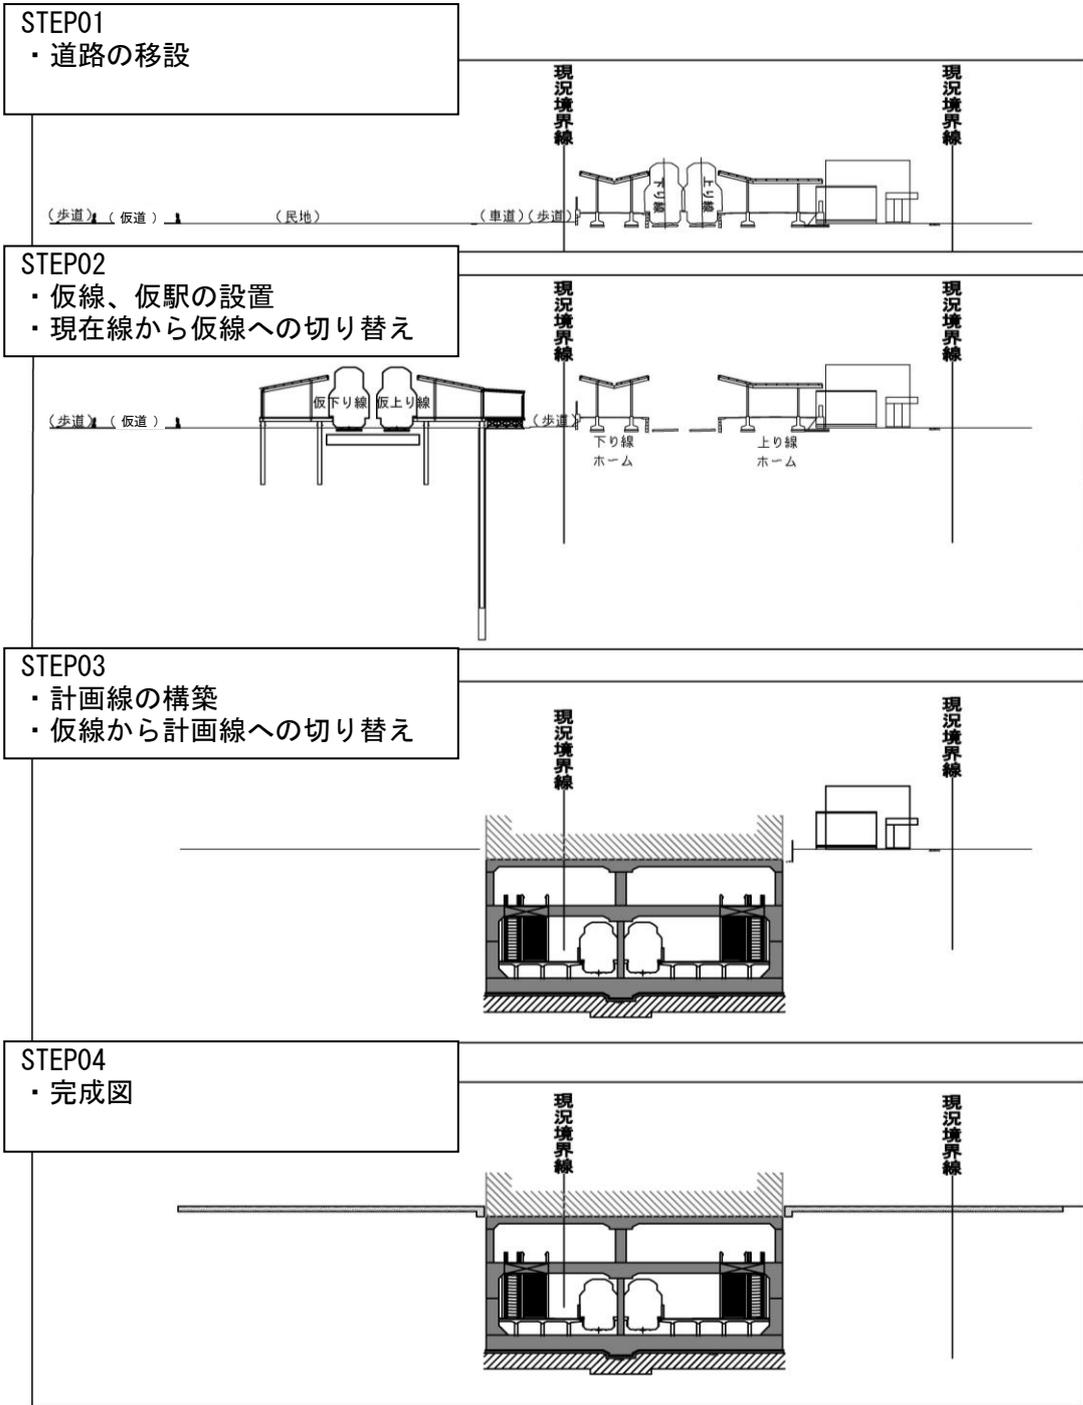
施工ステップ図 (駅部：川崎大師駅)
